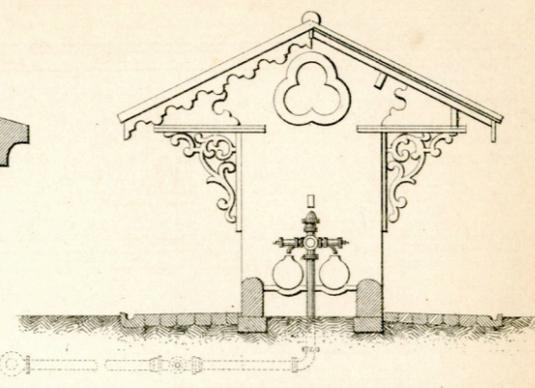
e 13. Pianta e Sezione trasversale. - 1 a 100.
